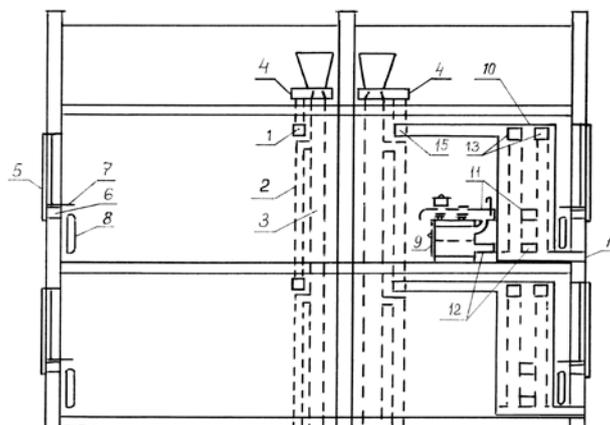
Комплексная схема теплогазоснабжения и вентиляции герметизированных высотных зданий с теплыми чердаками: 1 – вытяжная вентиляционная решетка; 2 – ответвление канала вытяжного вентблока; 3 – ствол вытяжного канала вентблока; 4 – эжекторный оголовок вытяжной вентшахты; 5 – солнечный подогреватель воздуха; 6 – рекуперативный приточный вентиляционный элемент; 7 – подоконная плита; 8 – отопительный прибор; 9 – газовая плита; 10 – теплообменник газовой плиты; 11, 12 – верхний, нижний присоединительные патрубки; 13 – выпускные отверстия; 14 – воздухоприемные отверстия теплообменника газовой плиты; 15 – присоединительный патрубок теплообменника к вытяжному каналу
